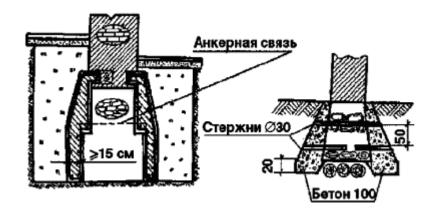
Укрепление железобетонными обоймами Рис. 2. Укрепление бетонными подушками
